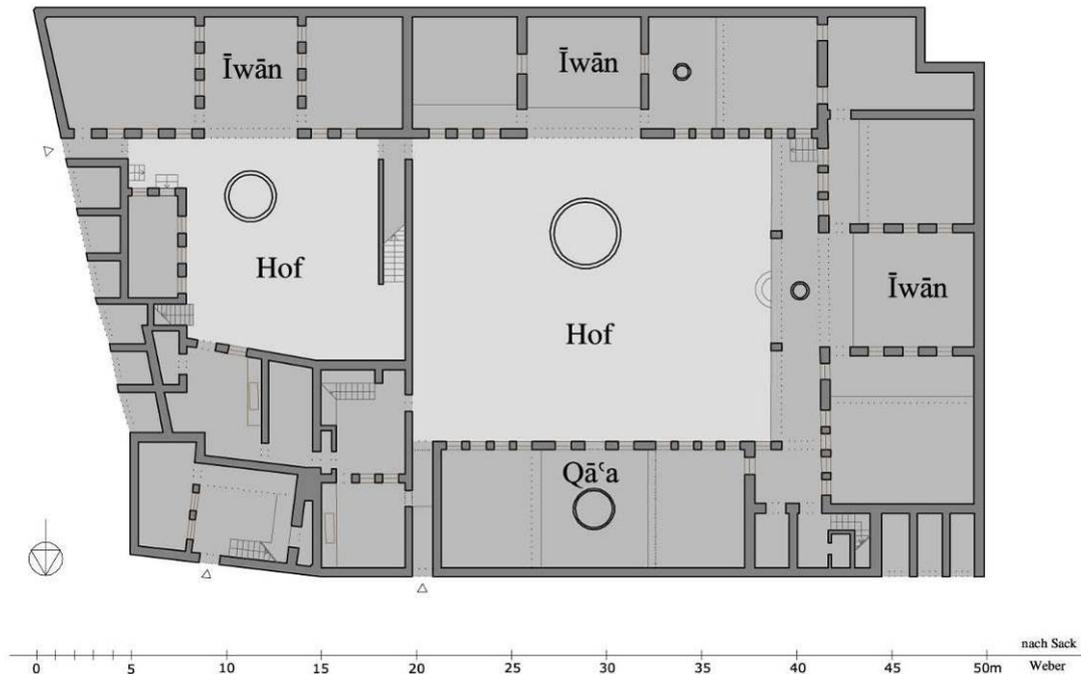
Bayt Farḥī / ad-Daḥḍaḥ, Grundriss
